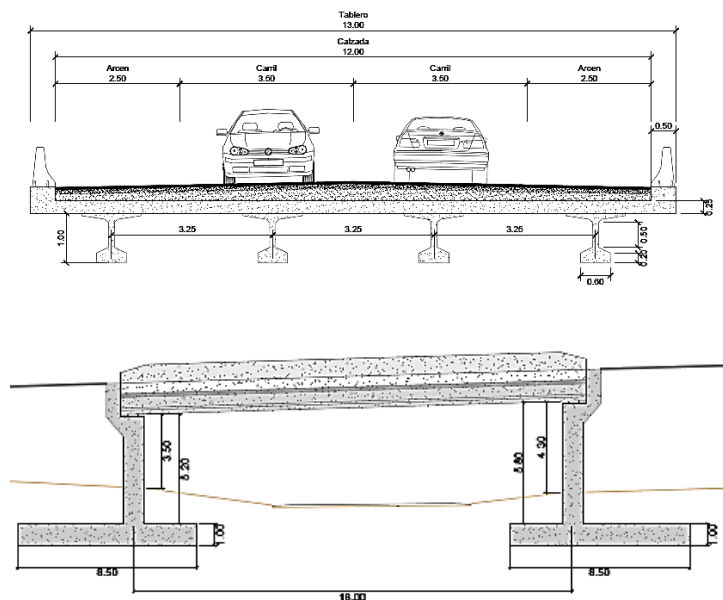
Sección tipo y sección longitudinal del Puente 1
